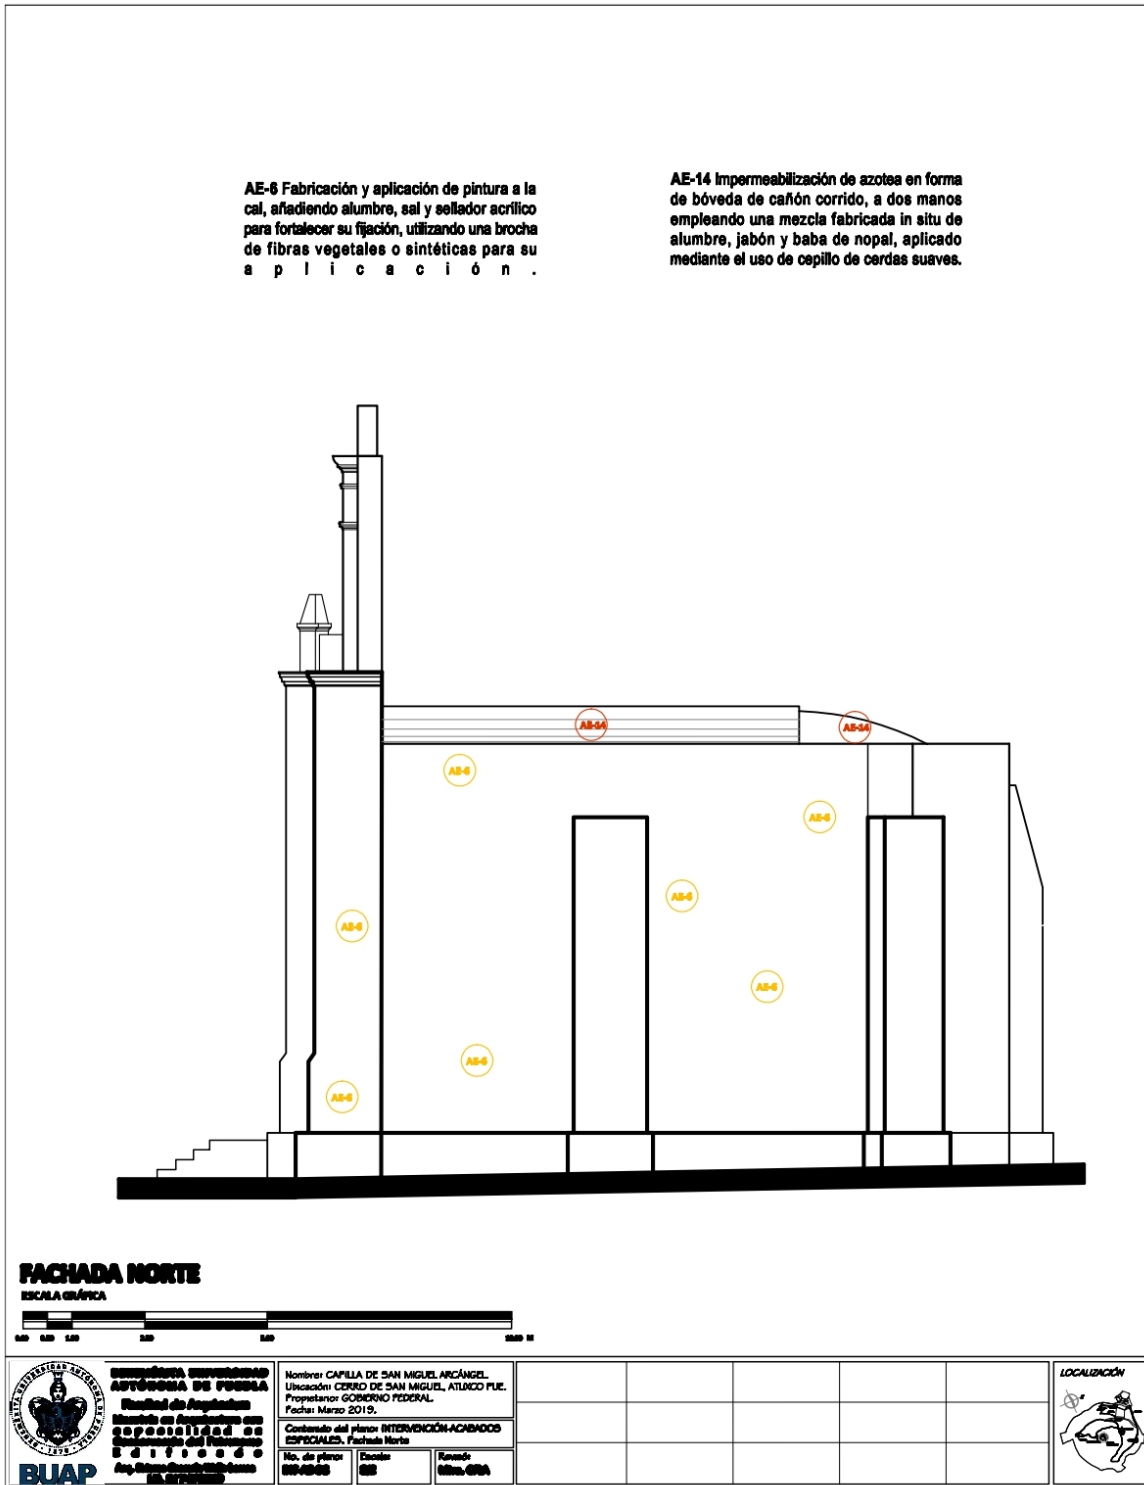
Plano 6 de acabados especiales en fachada norte.
